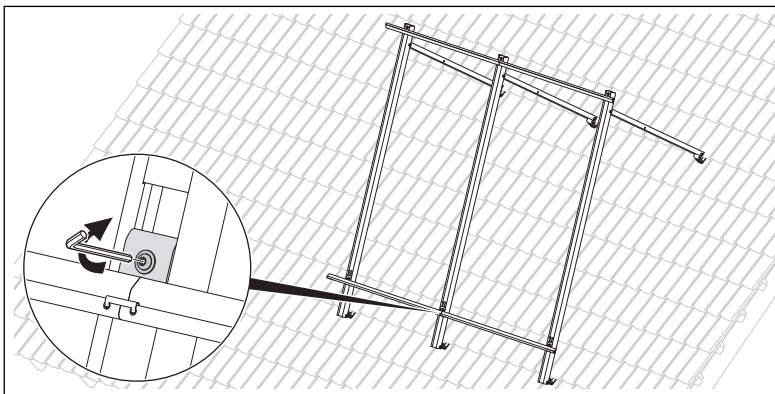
Fissaggio delle guide di montaggio in basso
